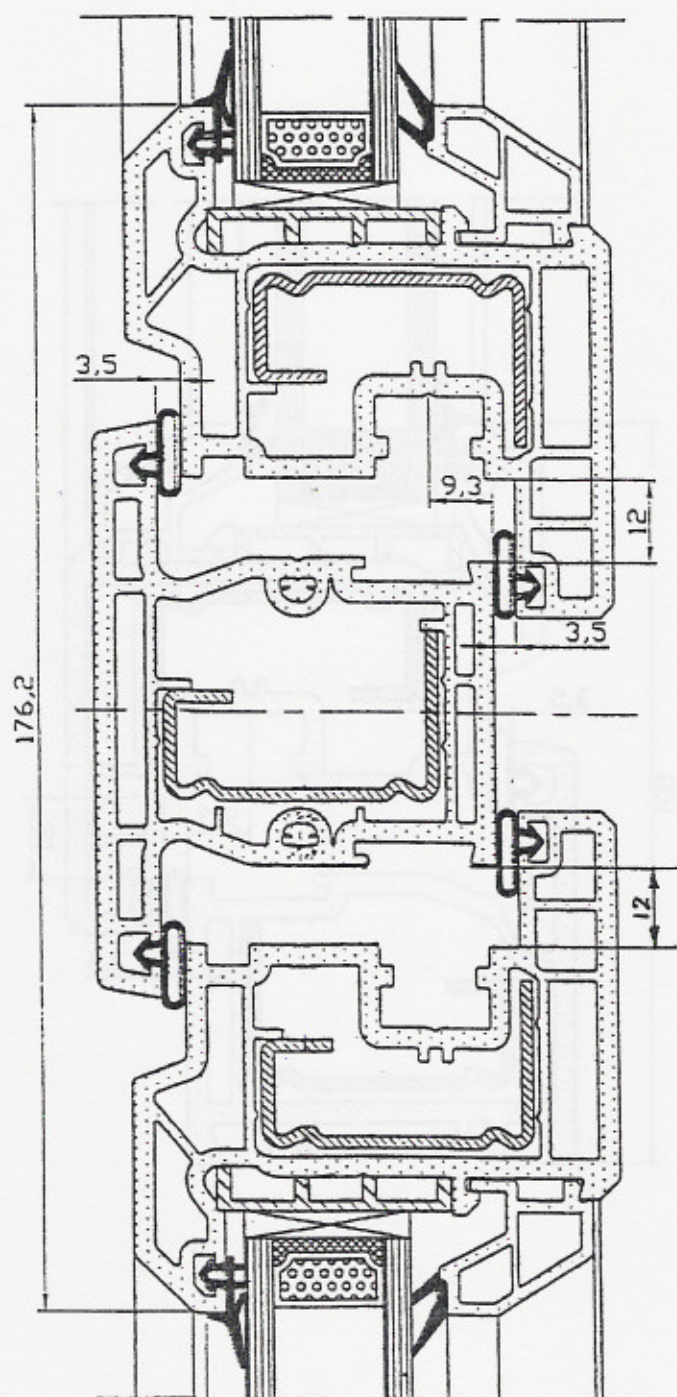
Przekrój przez ramę okna stałego systemu ERGO PLUS
